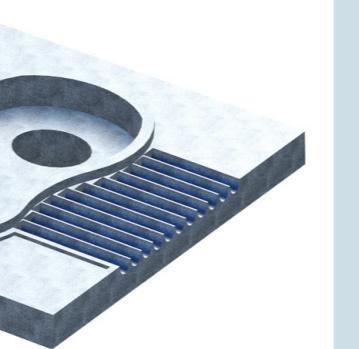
Sección Vivienda Rodríguez Planta Baja
